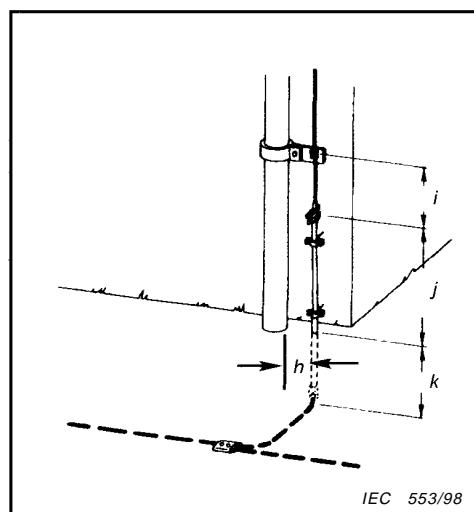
Installation d'une borne d'essai sur un conducteur de descente et connexion à une descente de gouttière
